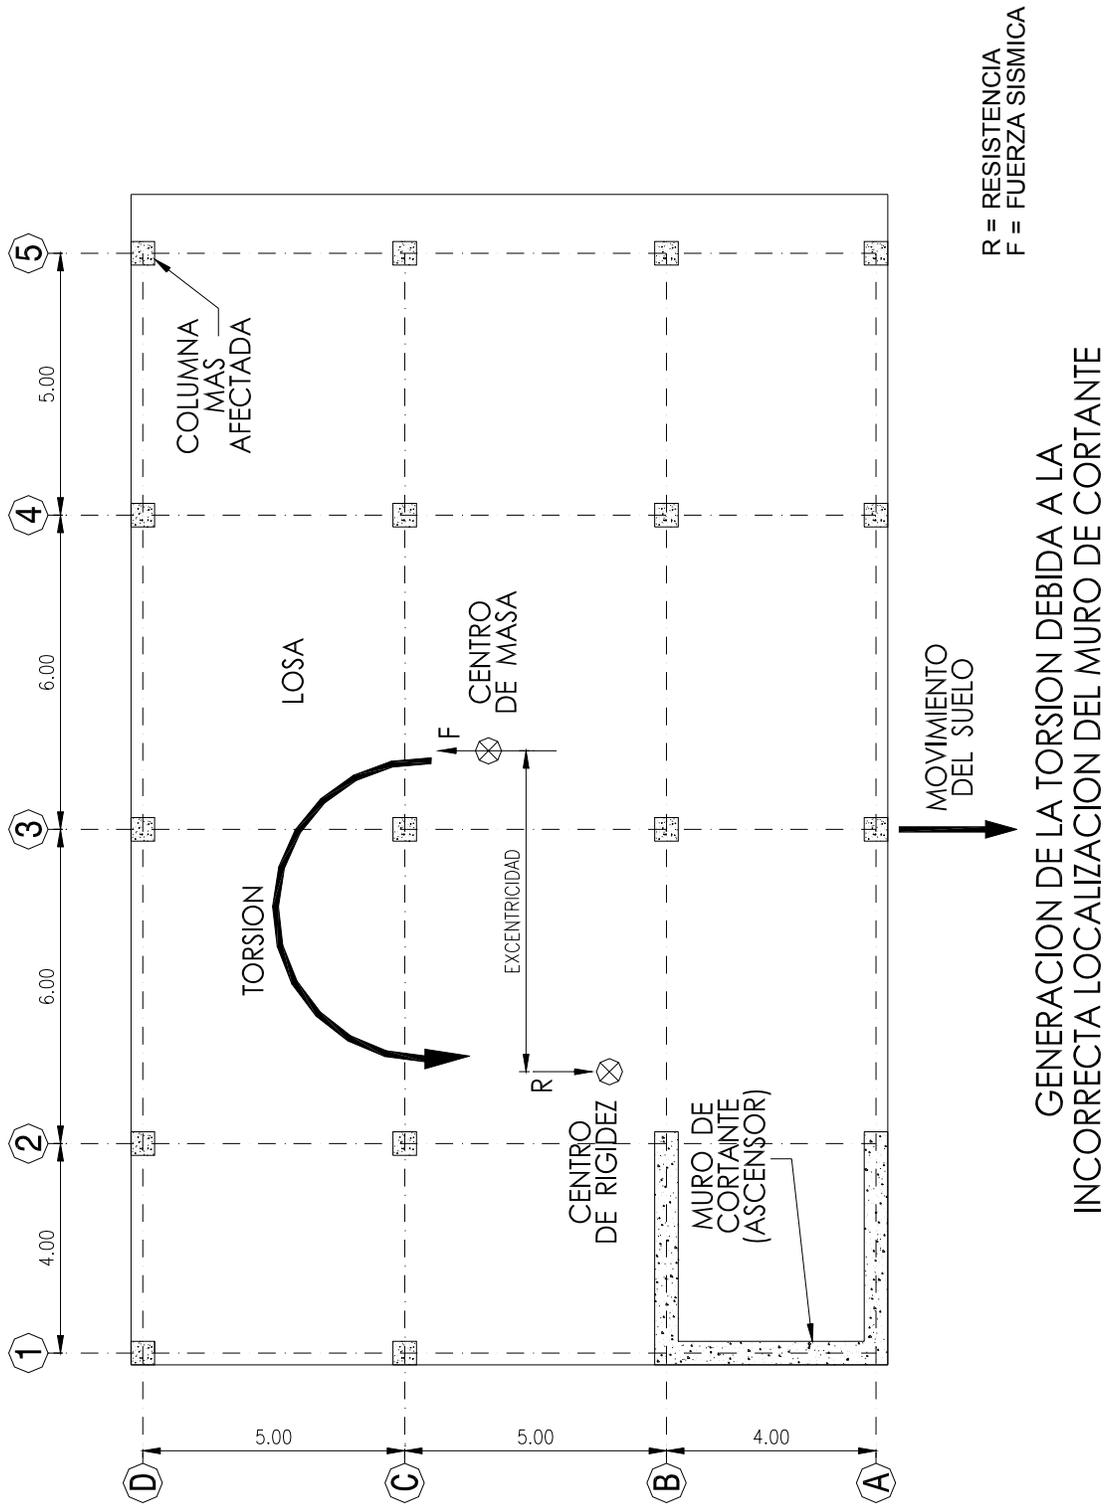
Torsión generada por la incorrecta localización de muros de cortante.
